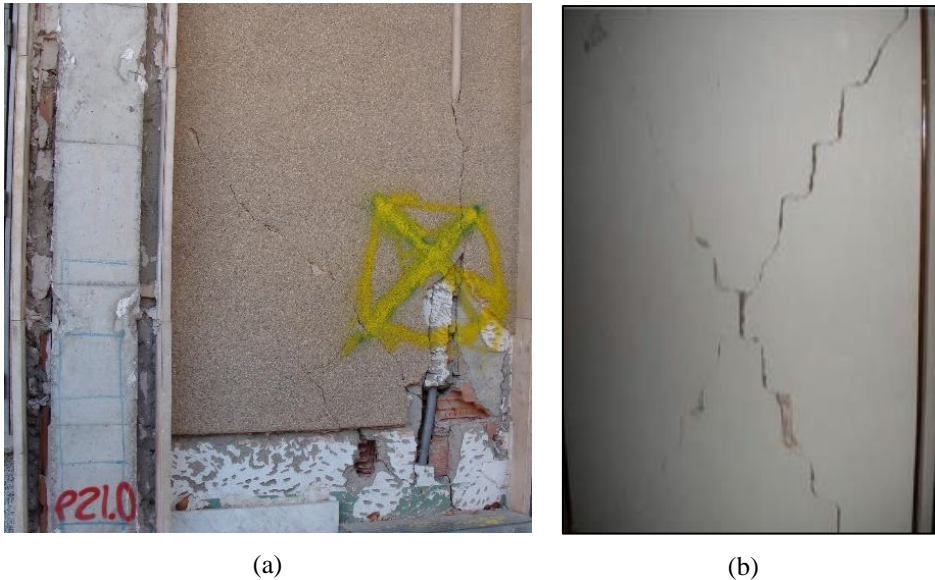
Daño típico en muros no-estructurales de mampostería en (a) planta baja y (b) plantas superiores (Ratzlaff, 2011).
